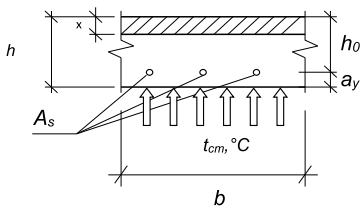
Расчетное поперечное сечение балочной плиты, схема обогрева стержней рабочей арматуры в условиях стандартного пожара: h и h_0 – высота поперечного сечения балочной плиты и ее рабочая высота, мм; a_y – глубина заложения рабочей арматуры балочной плиты, мм; A_s – площадь рабочей арматуры балочной плиты, мм²; x – высота сжатой зоны поперечного сечения, мм
